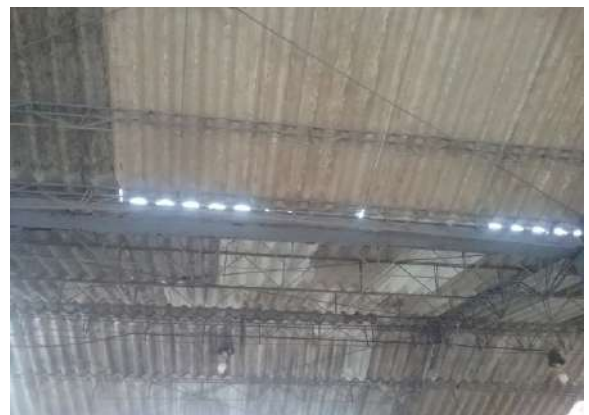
Estructura de cubierta en Centro de Mantenimiento
